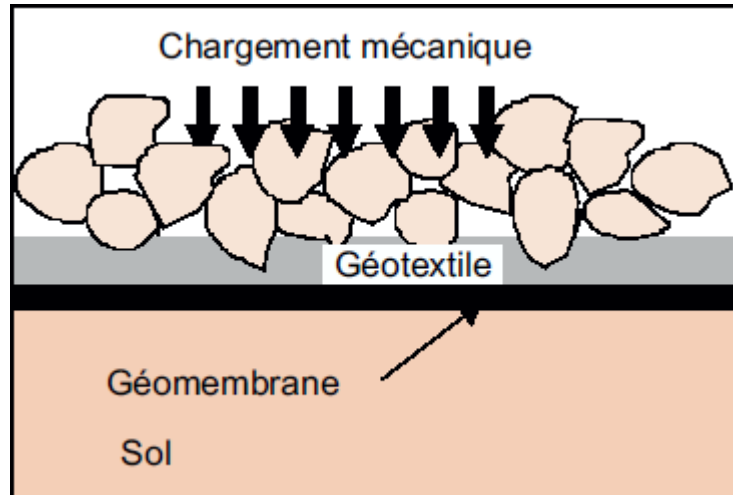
Protection du géo membrane par un géotextile. (GUEFAIFIA & BENRDJEM, 2020)
